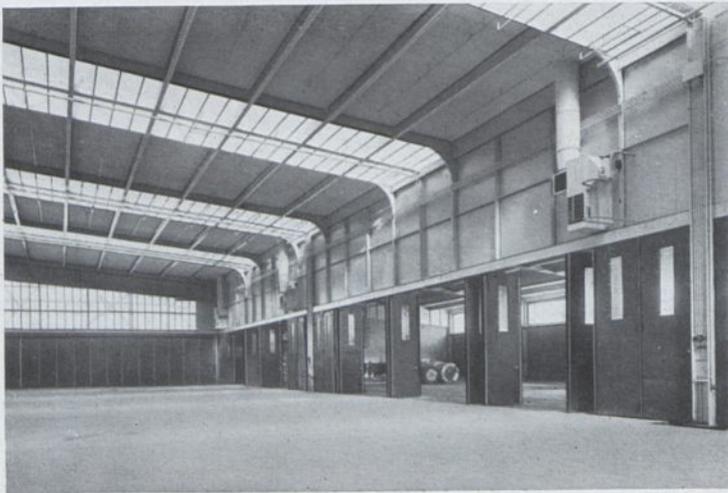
Blick von der Mittelhalle in eine Seitenhalle mit Ansicht des Unterzuges.
